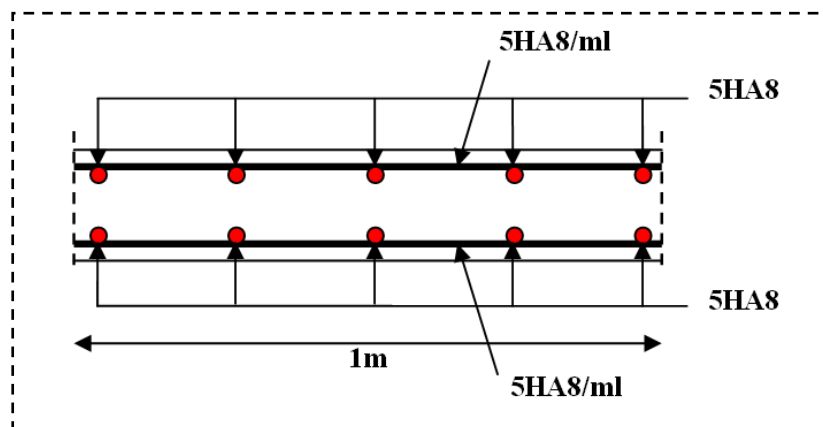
Schéma de ferrailage de la dalle pleine 1^{ère} type
